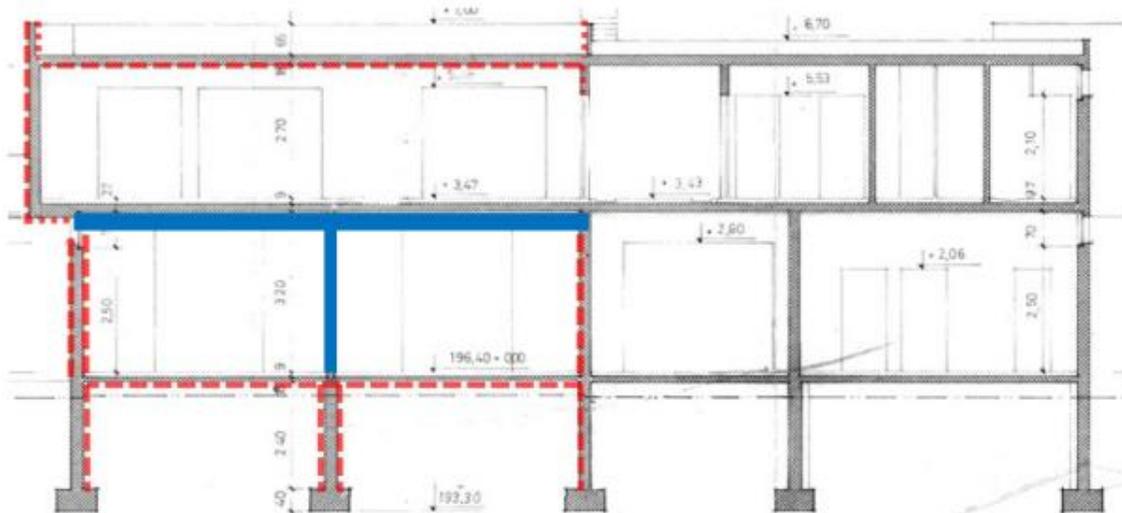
Sezione trasversale con intervento di rinforzo (blu) e risanamento (rosso) - Variante 4.
